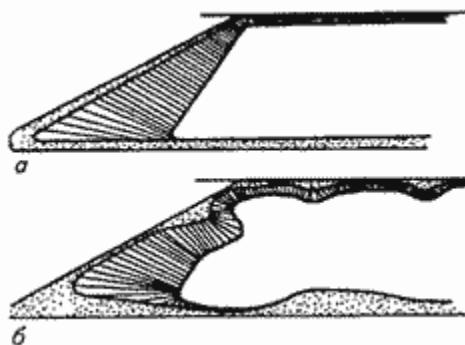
Карьерные разработки: а – форма разработки карьера в плане (прямоугольная); б – формирование извилистой береговой линии при выемке грунта в карьере
